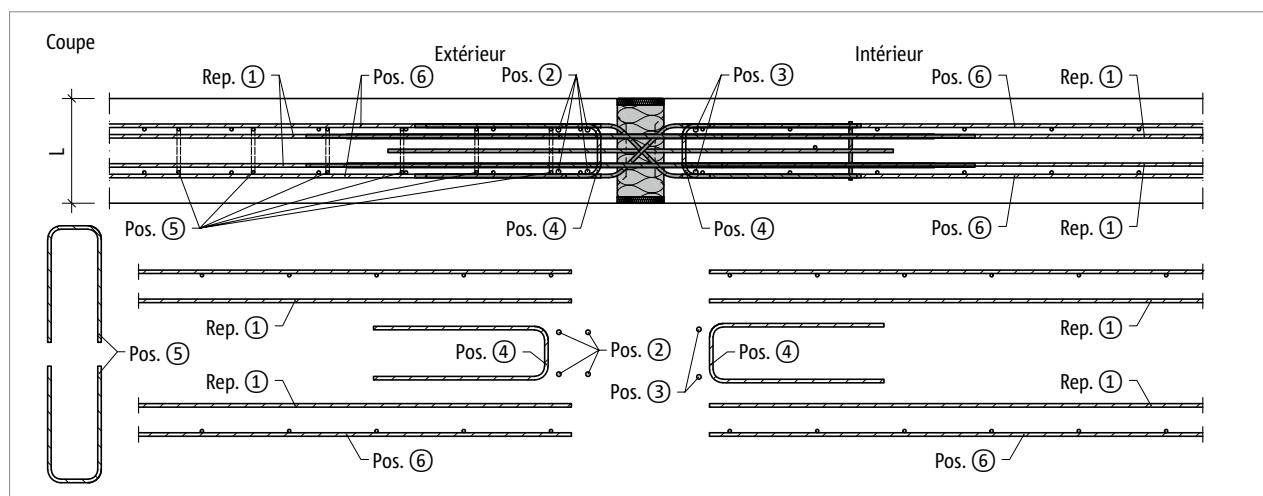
Schöck Isokorb® T type W : Renforcement sur site ; projection horizontale
